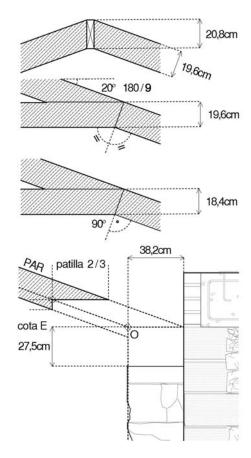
Dimensionado de la hilera, pares y estribo alto (dibujo del autor)
